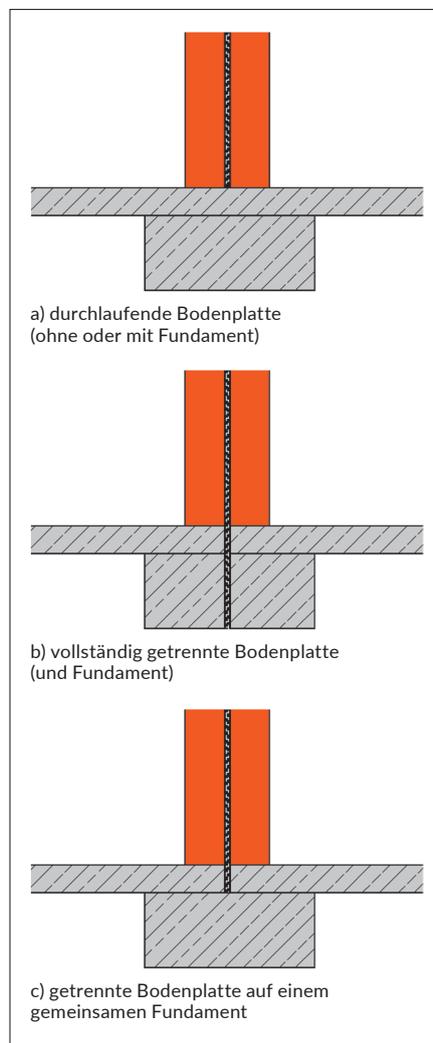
Darstellung unterschiedlicher Fundamentierungen im Bereich einer zweischaligen Haustrennwand.
